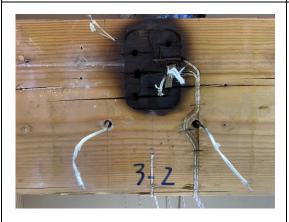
試験体 3-2 耐火構造壁内の梁(ベイマツ製材)表面
